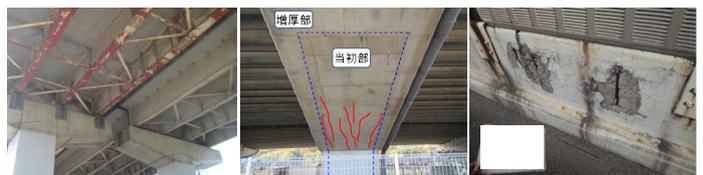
現地状況 (左: PCB 塗膜, 中: ASR 損傷, 右: 塩害損傷)
